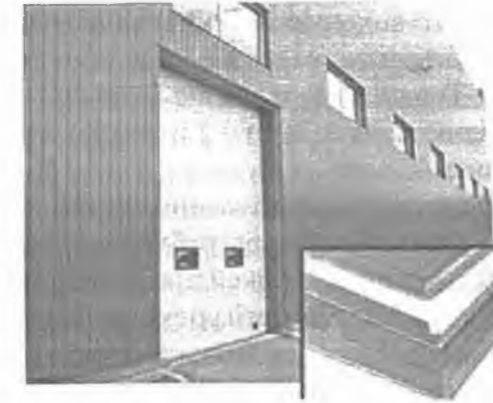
Фасад промислової будівлі із сендвіч-панелей із полімерним покриттям
